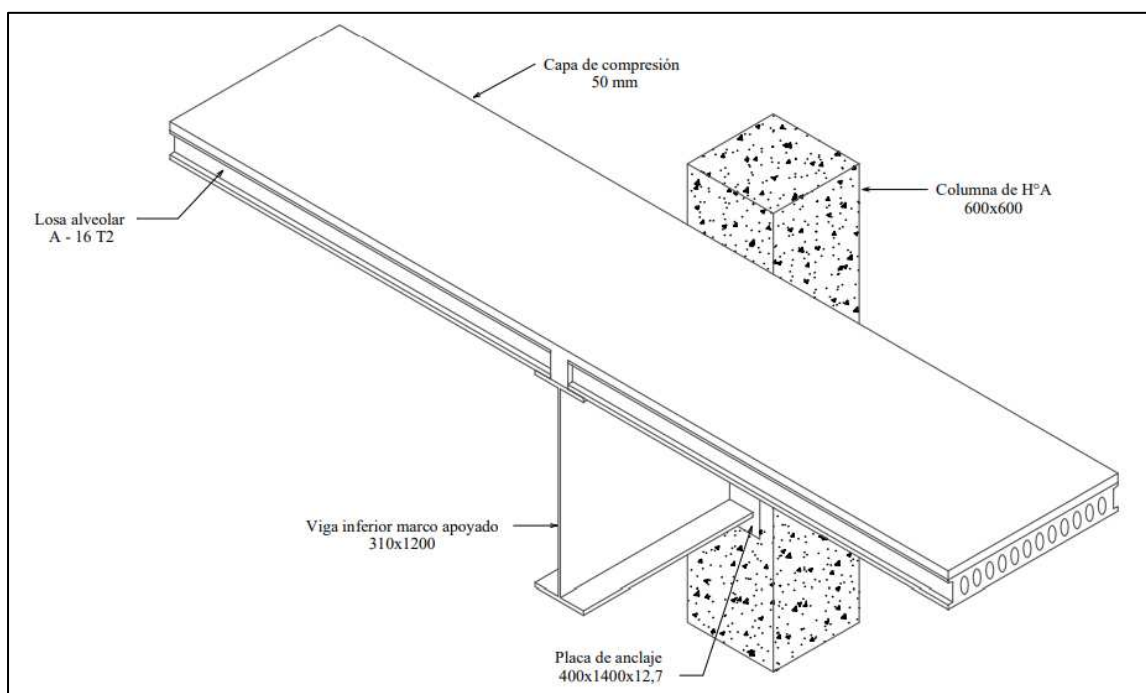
Colocación de losas alveolares de entrepiso. Fuente: Autor.
